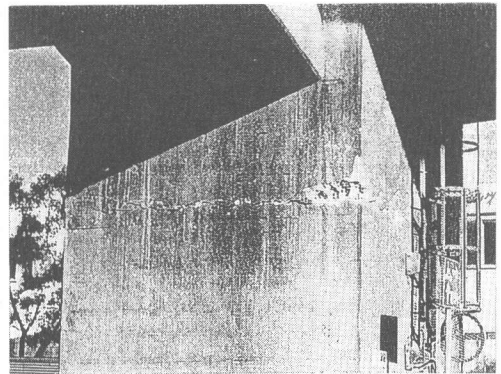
RC橋脚の水平輪切り状ひび割れの例
